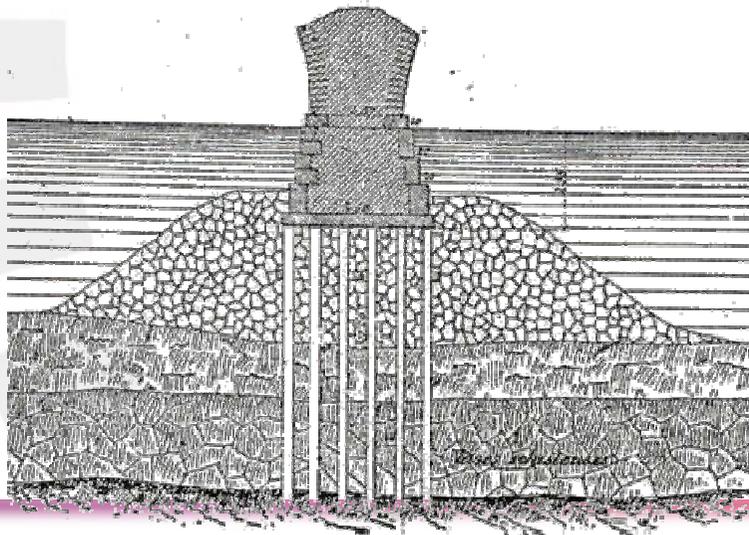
Pont de Bouchemaine sur la Maine. Caisson sur pieux.
